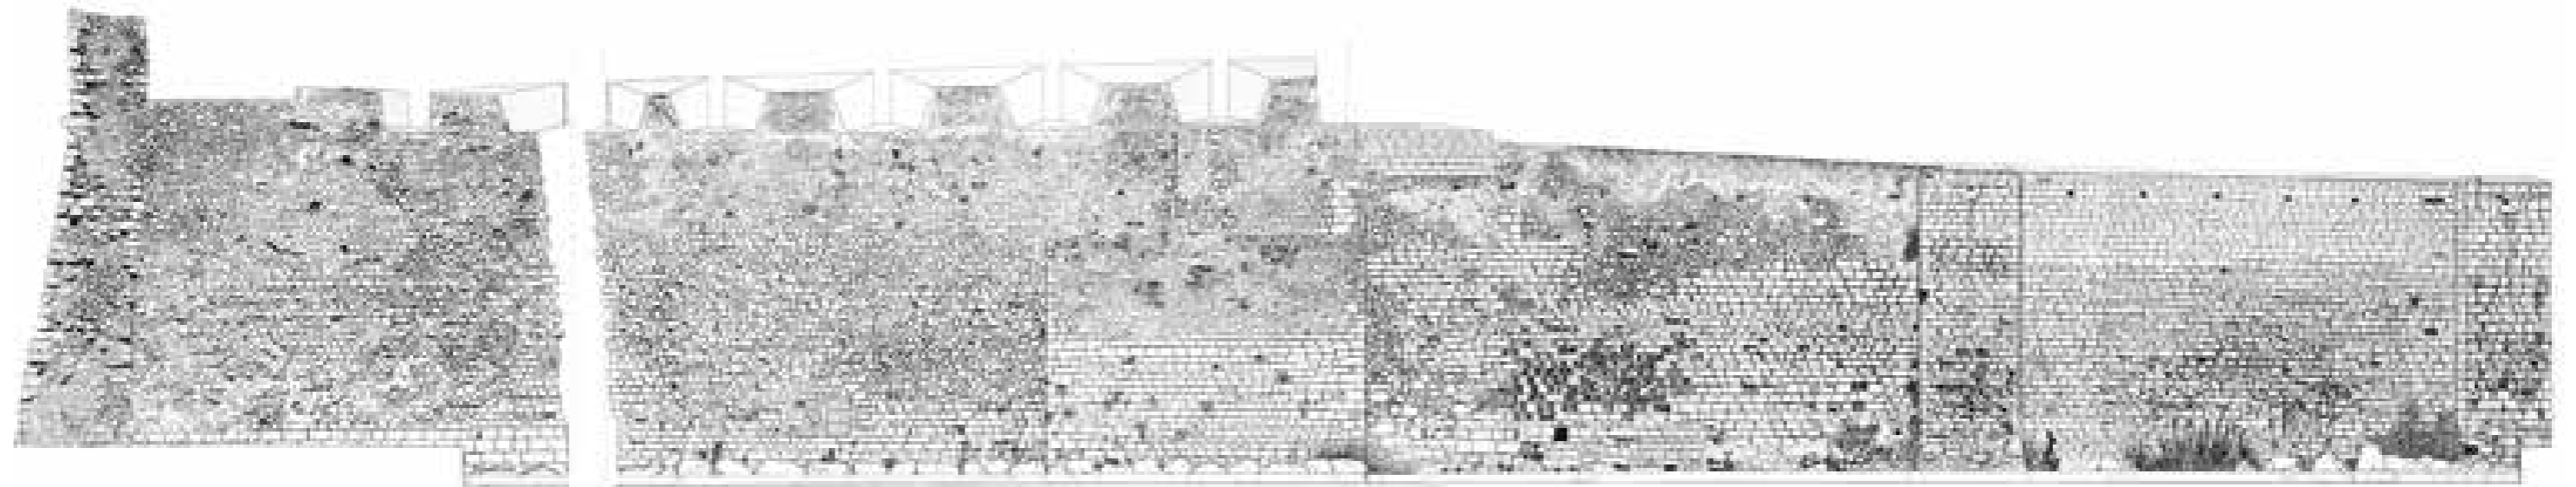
Alzado del Proyecto de intervención sobre la batería de Santa Ana y la muralla de la Fuente de Peñíscola, viendo el estado antes de la restauración. A la izquierda la sección de la muralla de Felipe II en el punto donde no se continuaría. Seguidamente la batería de Santa Ana y bajo los dos últimos merlones un gran contrafuerte y restos de piezas de sillería que pueden corresponder a las esquinas de la torre de la Fuente. A la derecha junto al contrafuerte, la muralla de la Fuente con las dos primeras torres, y los lienzos que han sufrido muchas reparaciones, sobretodo el primero que protege la zona del manantial. (MJB 2000).
